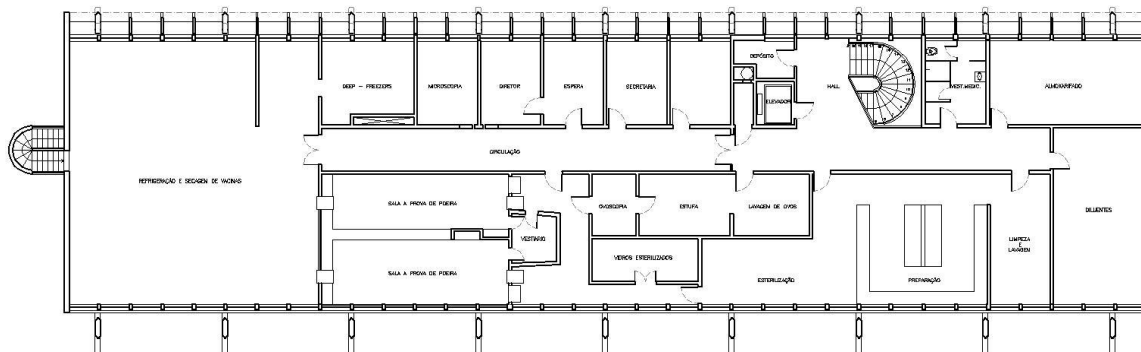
Redesenho da planta baixa do 2o pavimento, 1954. Fonte: DAD/COC/Fiocruz.
